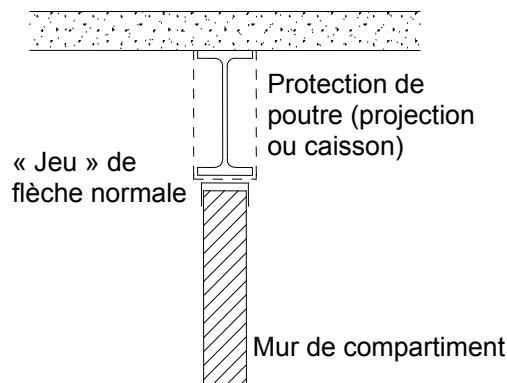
Poutres situées au-dessus et dans l'alignement de murs
